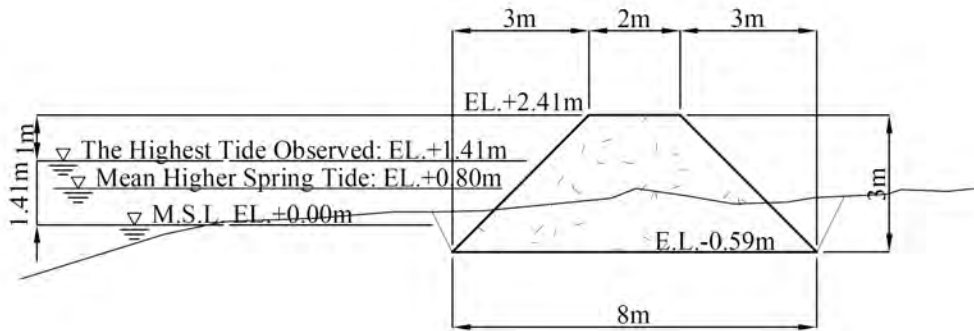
海岸堤 Type A (コンクリート堤防) 標準断面図
